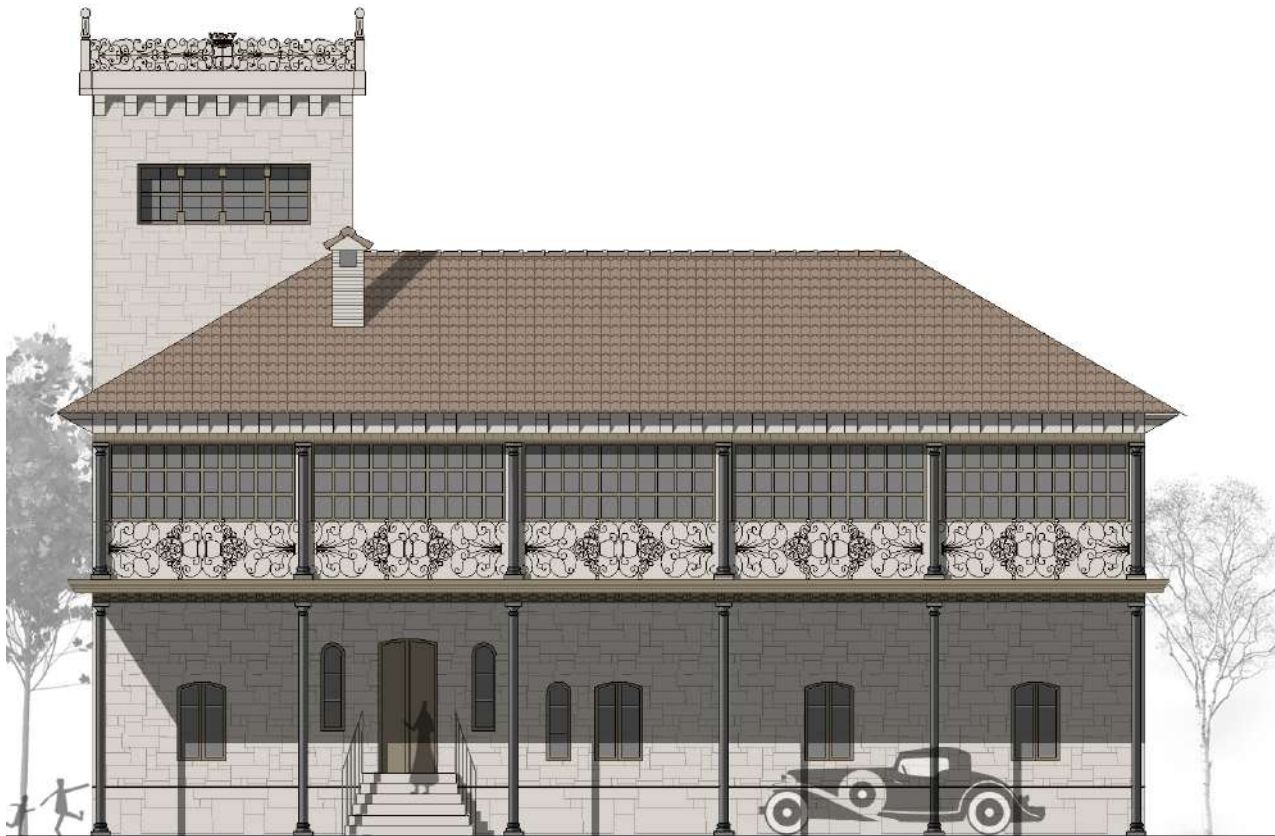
Segunda modificación de la fachada posterior (galería acristalada).
